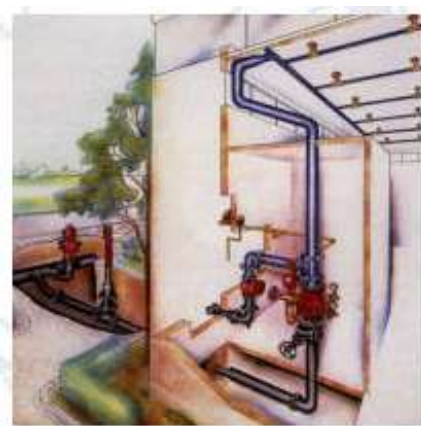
Vista assonometrica del montaggio di un sistema sprinkler
